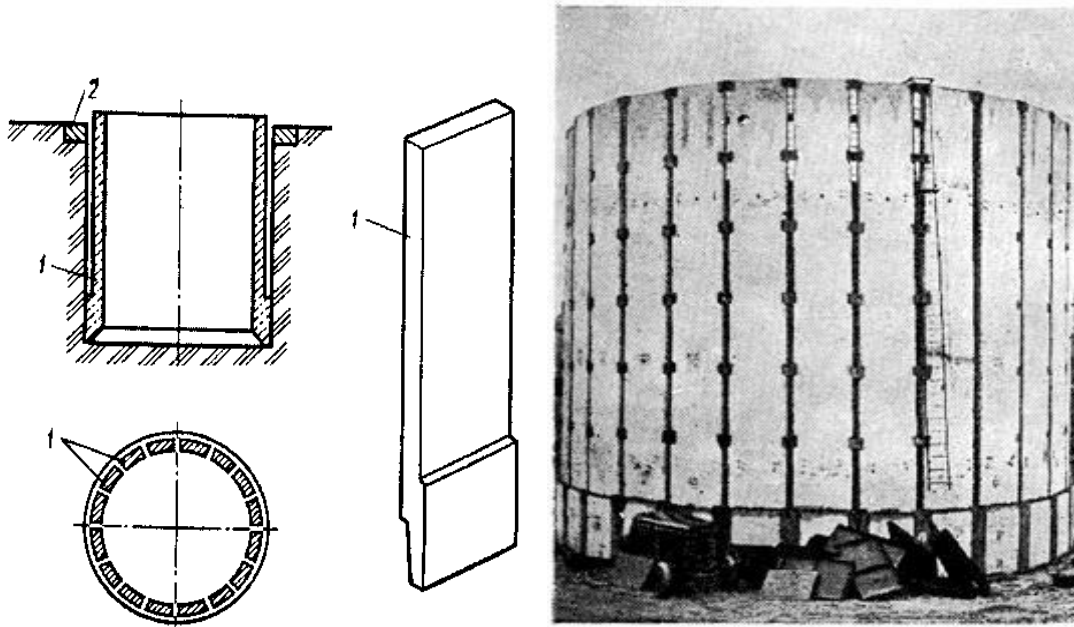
Збірний опускний колодязь із плоских суцільних панелей з вертикальним розрізанням елементів конструкції: 1 – панелі; 2 – форшахта
